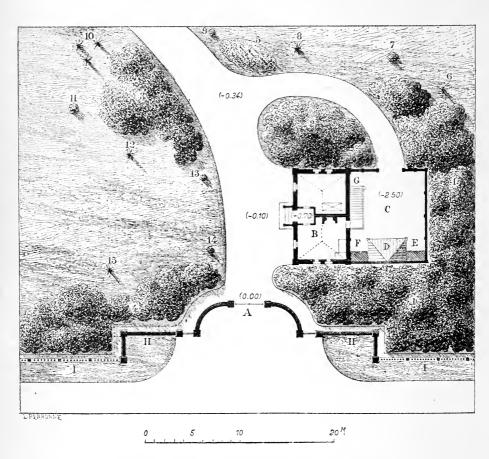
Plan de l'entrée principale du parc d'Avauges.
